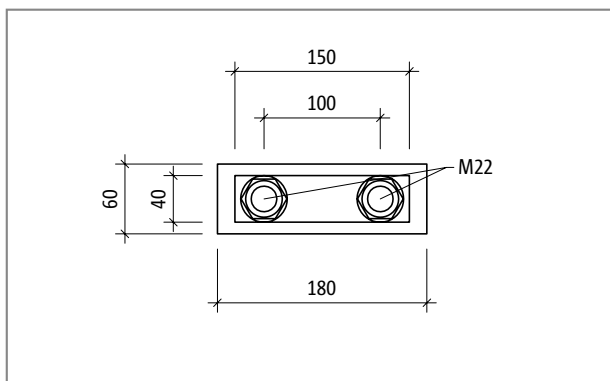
Schöck Isokorb® T typ S-N-D16: Řez prvkem
